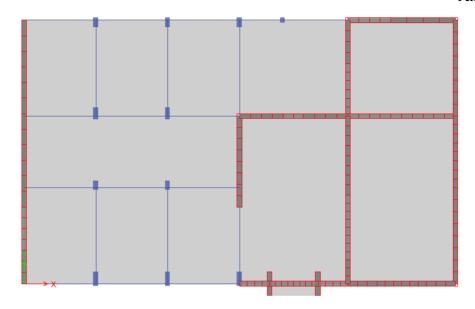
Planta primer y Segundo piso, Bloque B Municipalidad.
